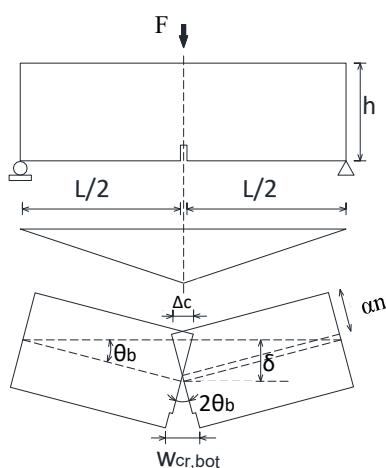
Mecanismo de falla de la viga idealizado. Fuente Lee et al. [9] modificado.
